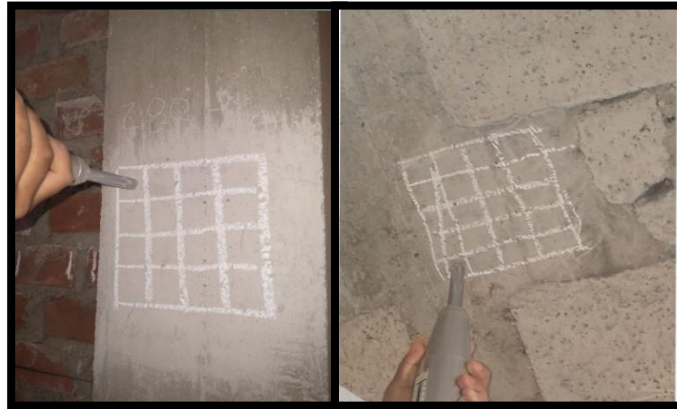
Lecturas con Esclerometria en la Columna y Viga Mz 16 Lt 11
